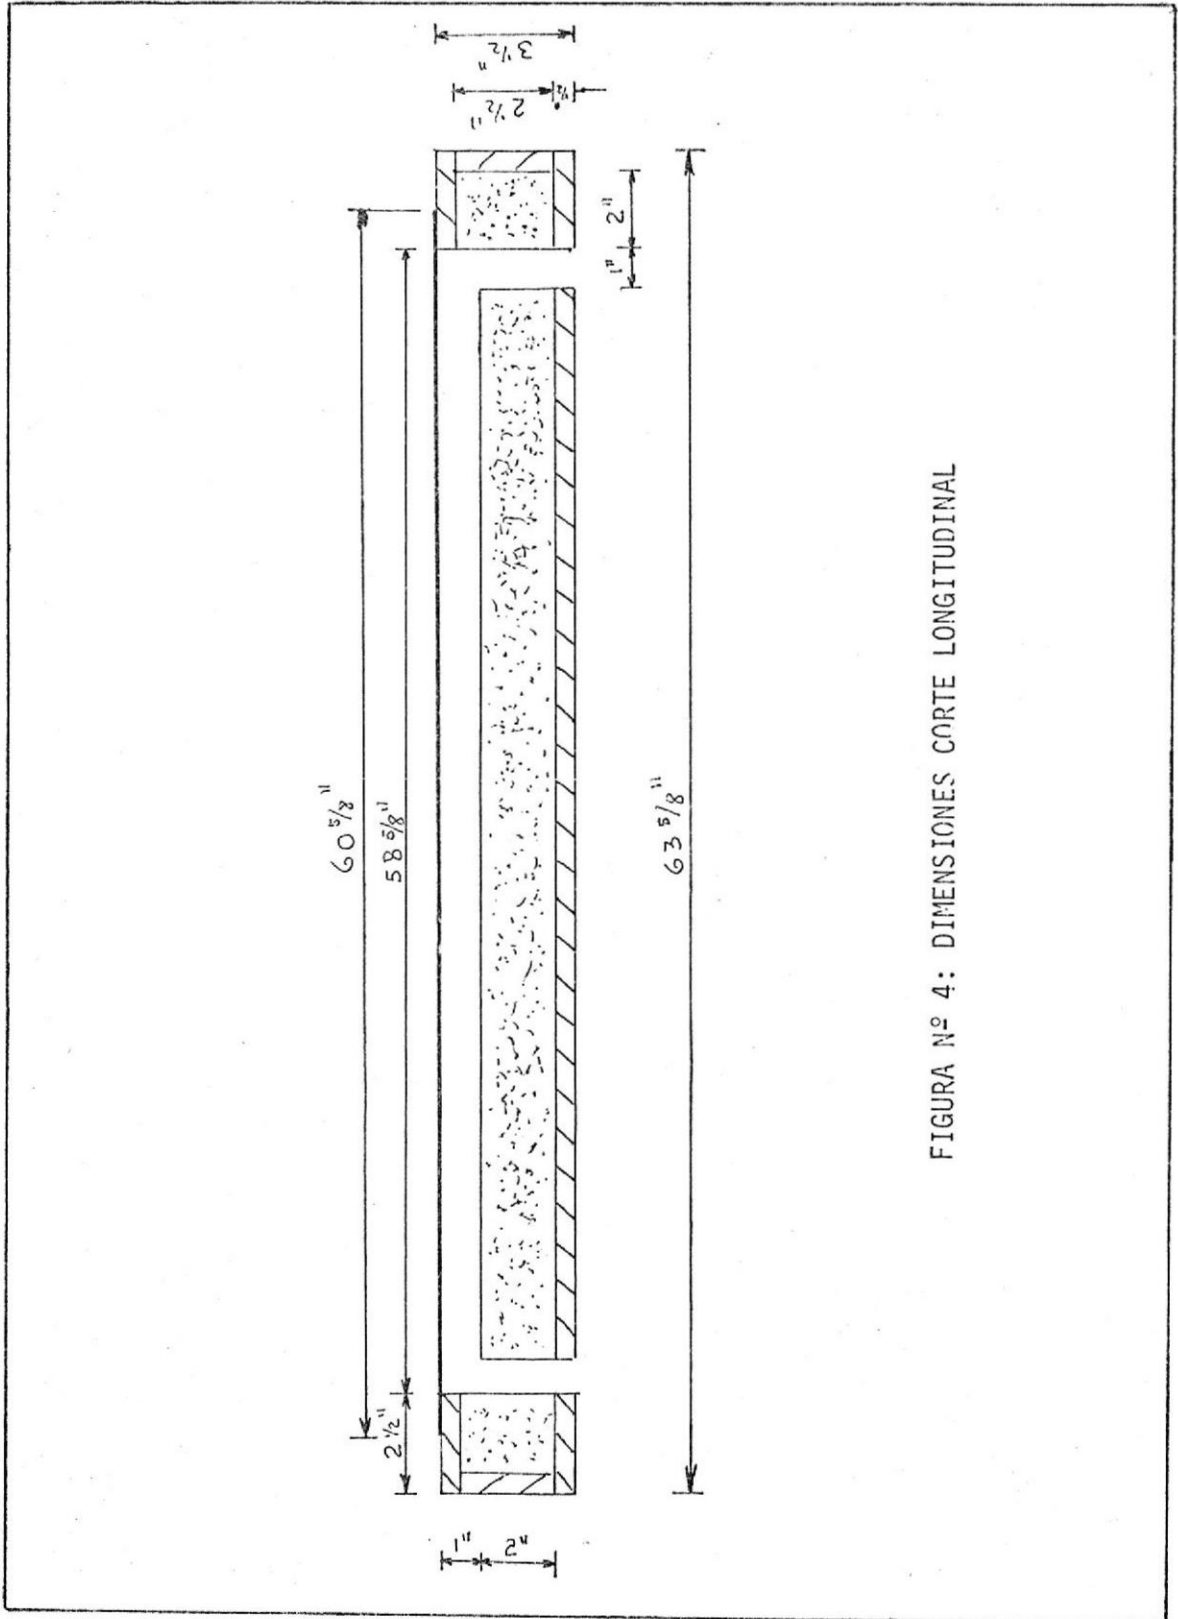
DIMENSIONES CORTE LONGITUDINAL
